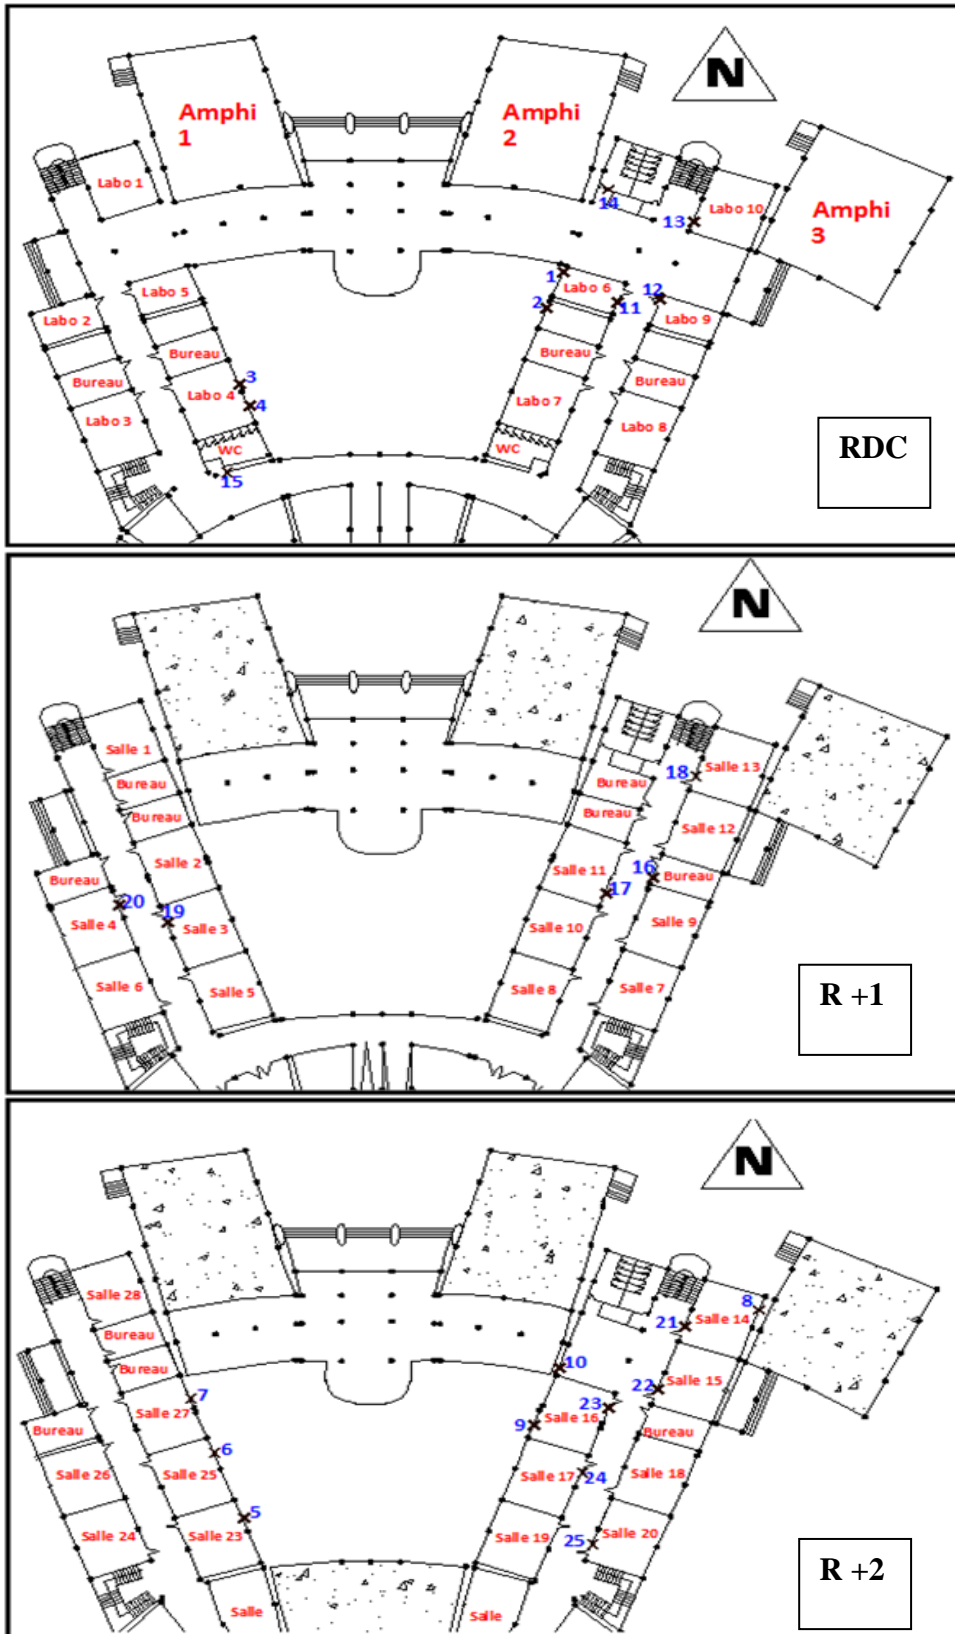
Indication sur les plans, des fissures apparues dans les ouvertures.
